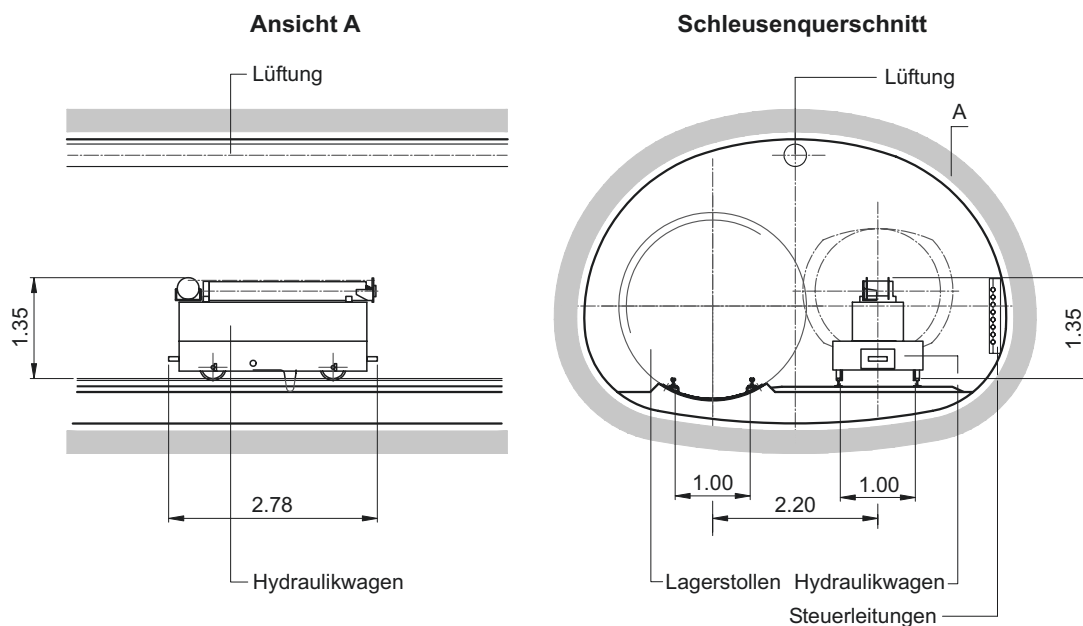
Hydraulikwagen – Seitenansicht und Ansicht in der Schleuse BE/HAA
